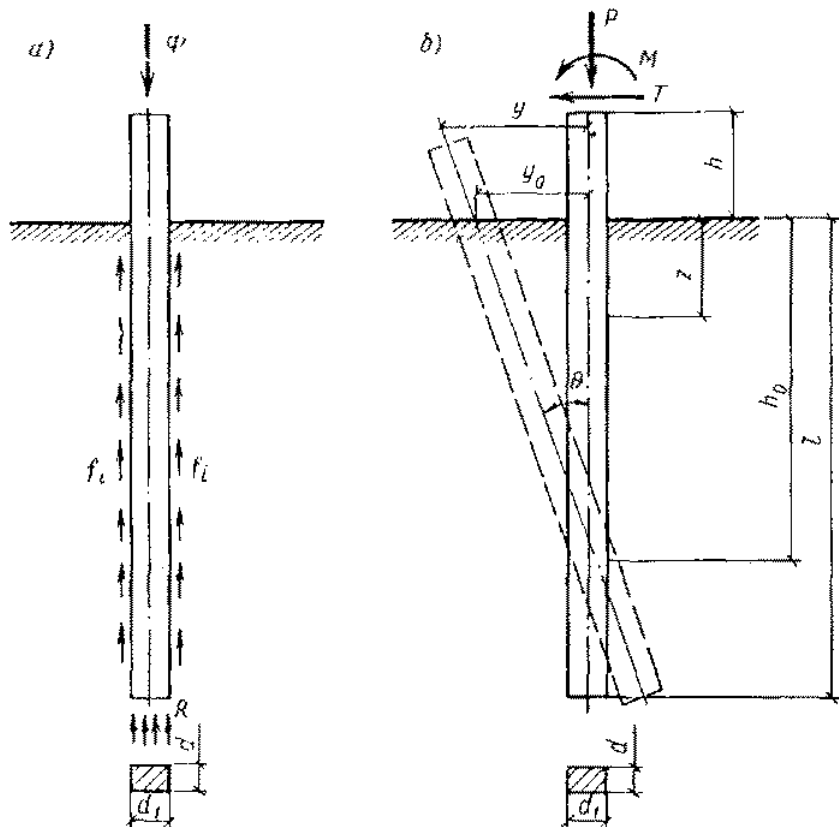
Расчетные схемы микровсвайных фундаментов теплиц:
